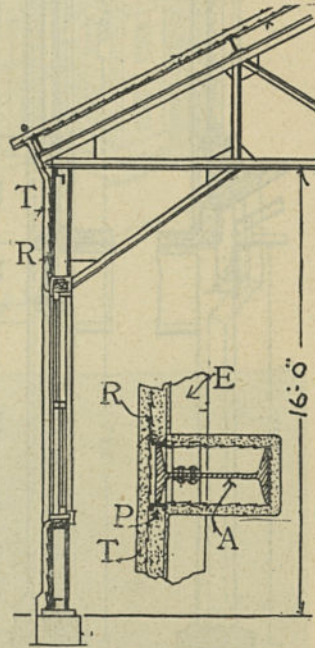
Coupe transversale. Détail en coupe horizontale.
